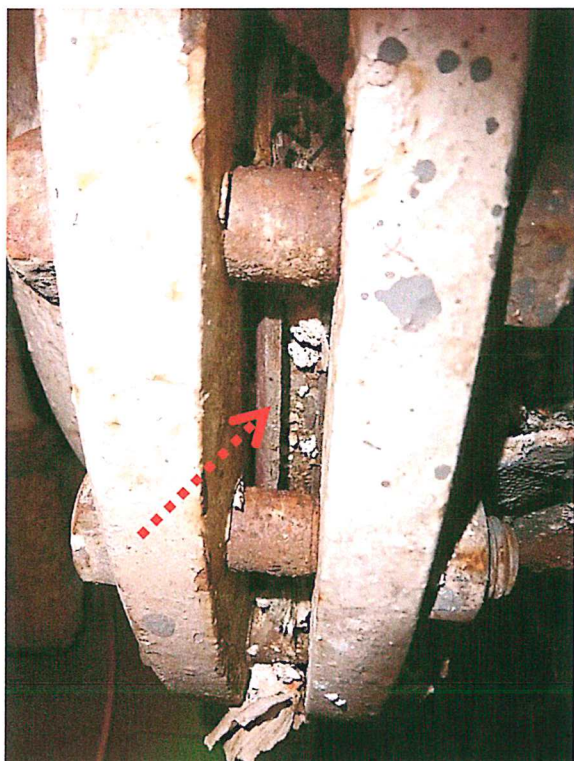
Detail uložení plochého těsnění v přírubě potrubí.
